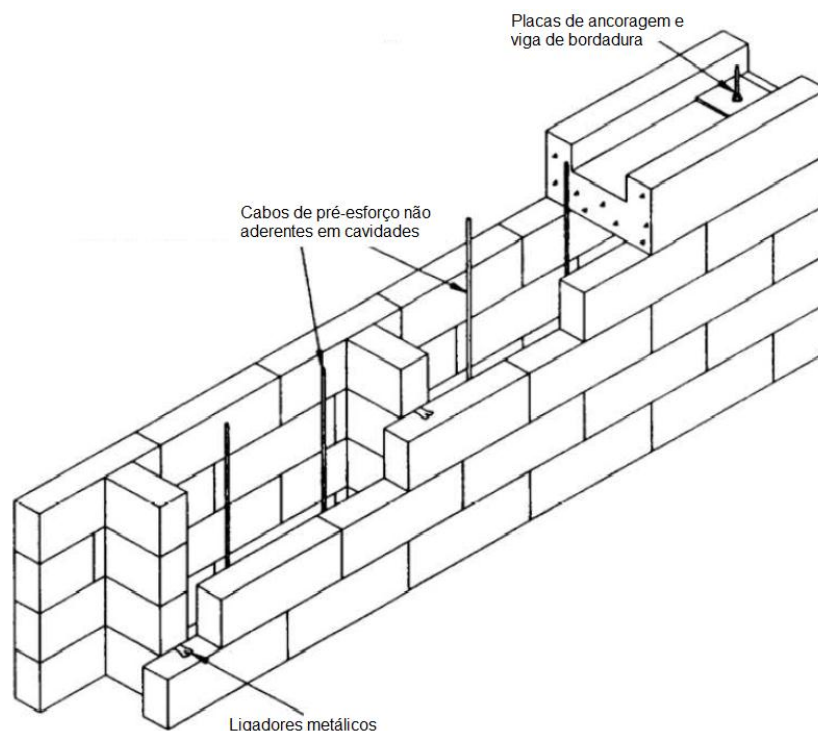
Elemento de alvenaria pré-esforçada, (reproduzido de Nave, 2008).
